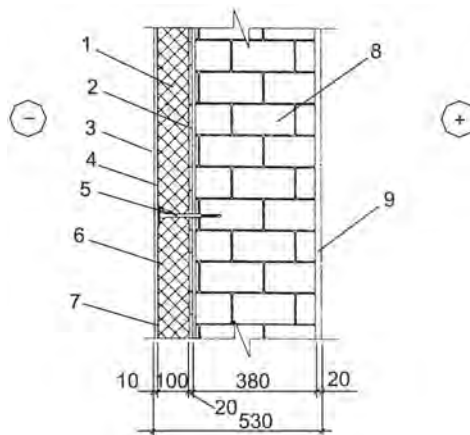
Утепление стены кирпичной кладки с применением для системы плит PAROC FAS-4: 1 — PAROC FAS 4; 2 — клей; 3 — отделка; 4 — грунтовка; 5 — деталь крепления каменной ваты; 6 — выравнивающий слой армирования; 7 — сетка арматурная; 8 — кирпичная кладка; 9 — внутренняя штукатурка
